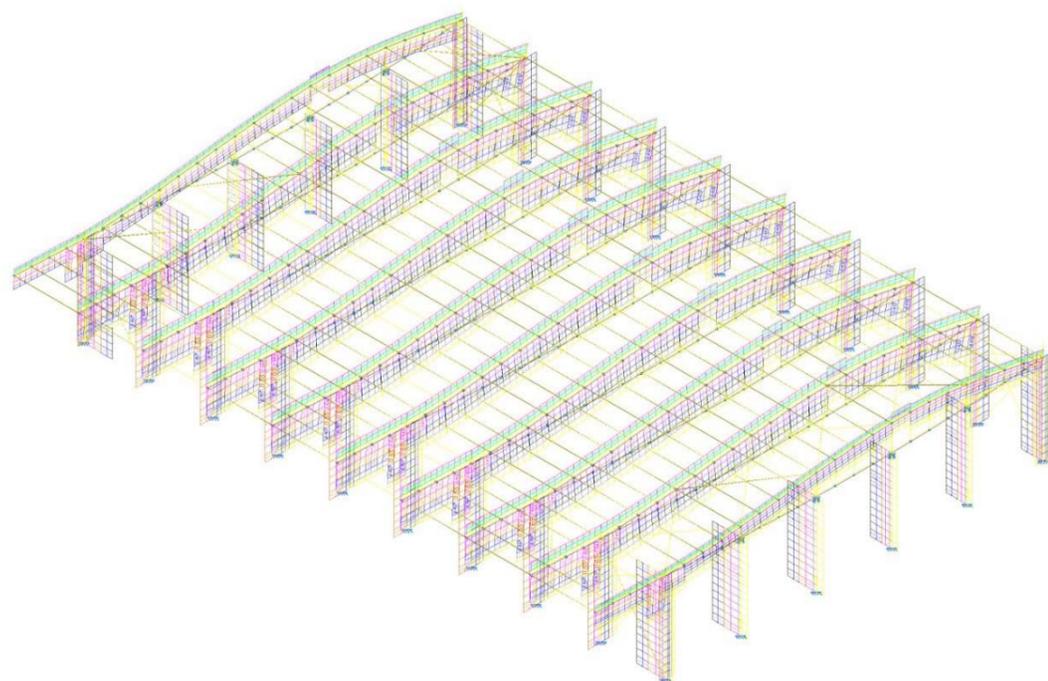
Cargas actuantes sobre la estructura en CYPE 3D
